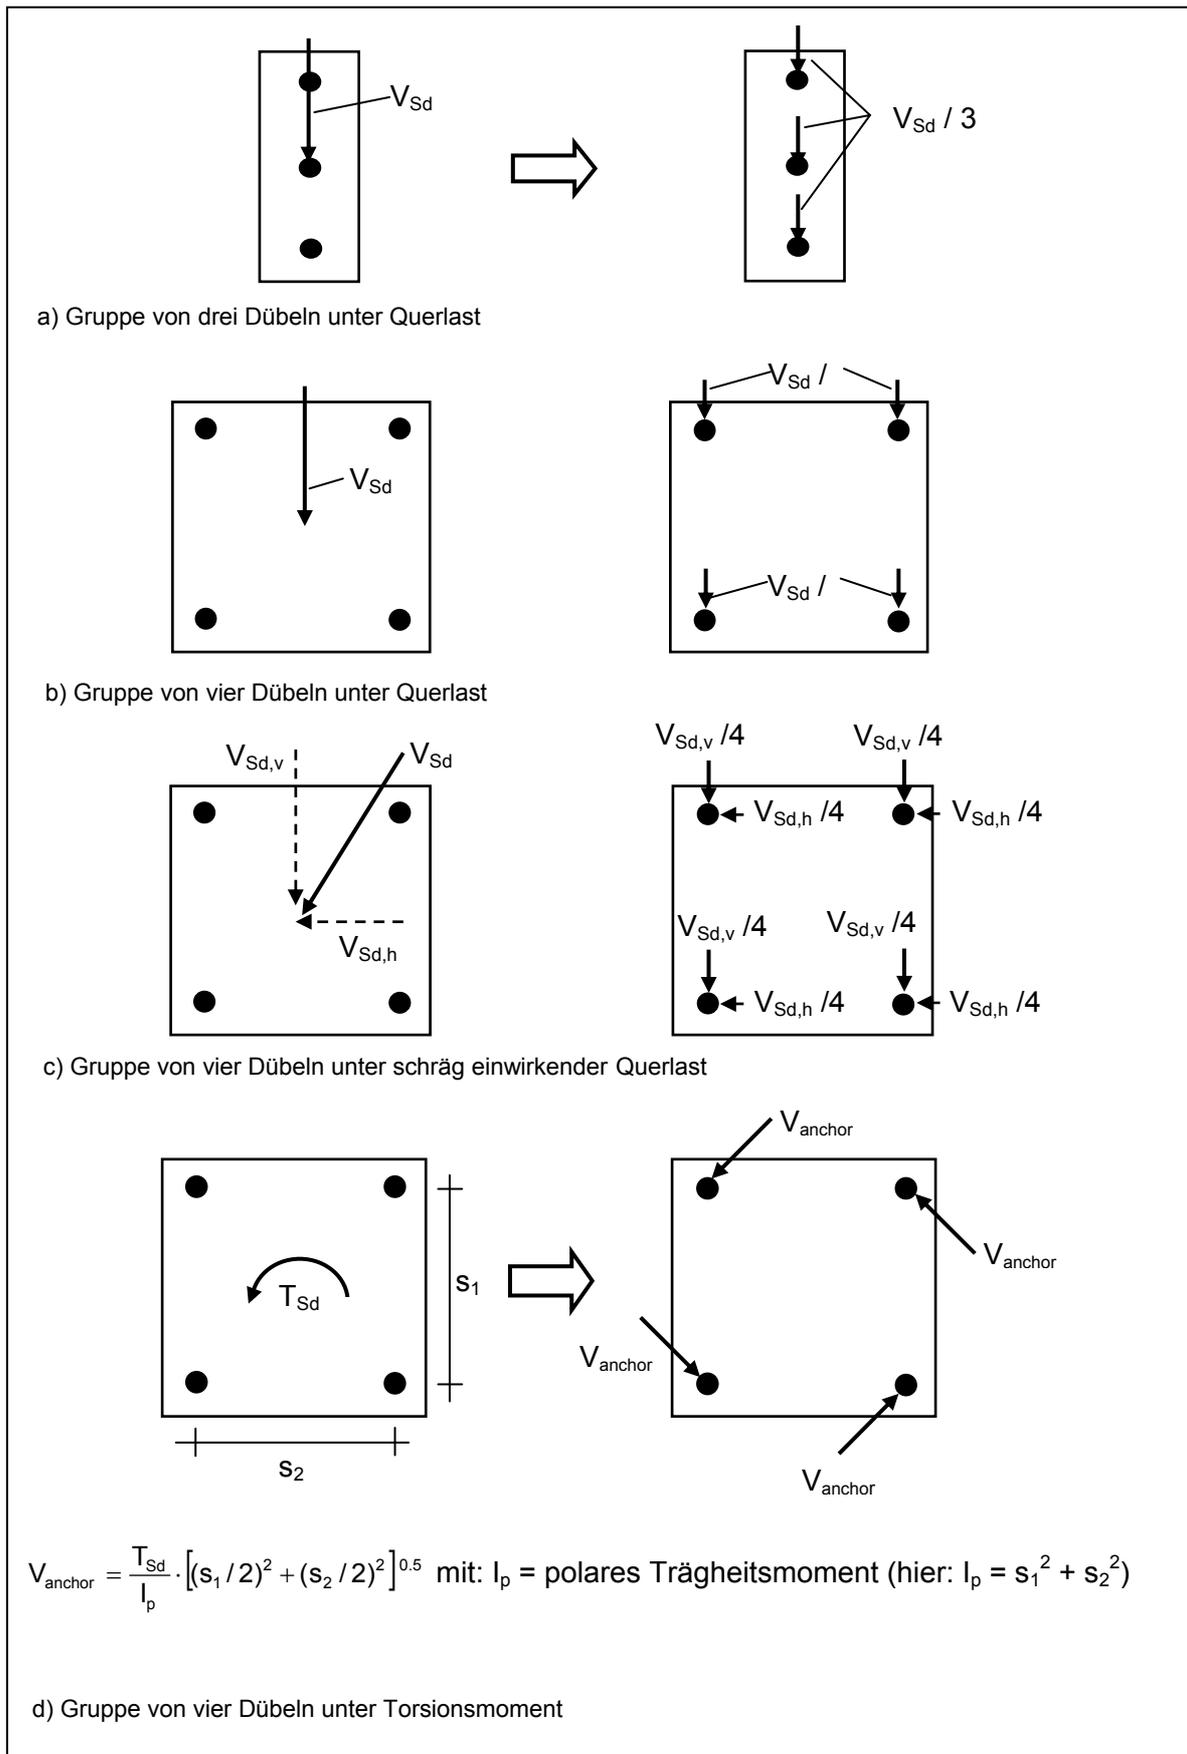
Ermittlung von Querlasten, wenn alle Dübel Lasten aufnehmen (Stahlversagen und Betonausbruch)
